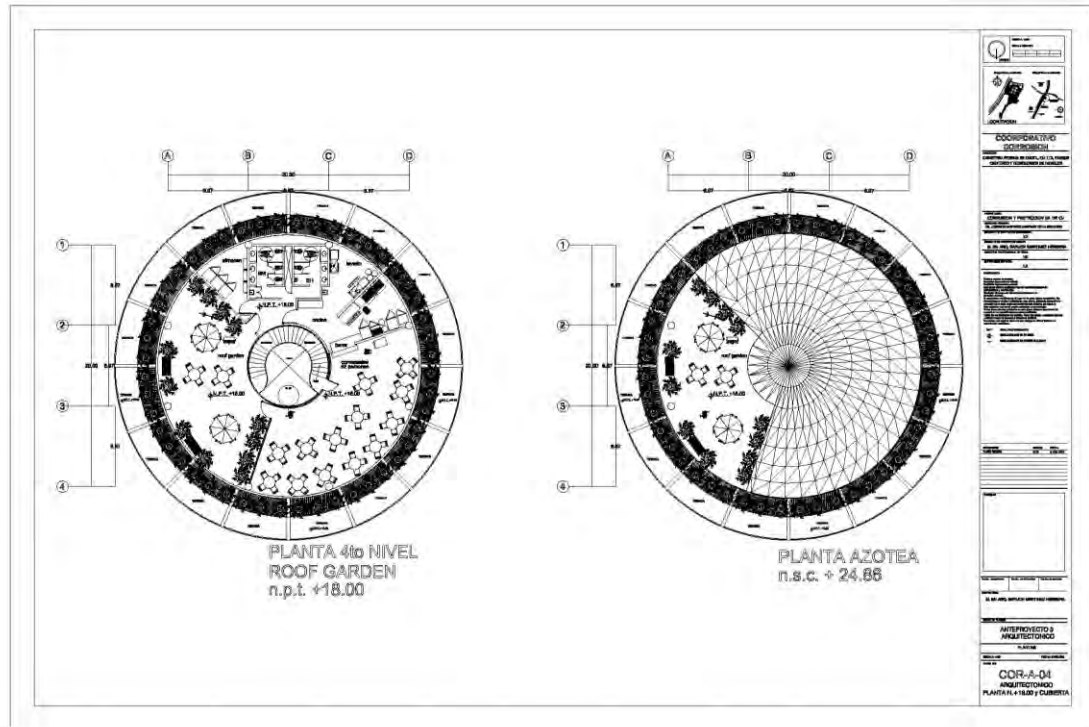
Plano arquitectónico 4to nivel y planta terraza, fuente Baruch Martínez.
